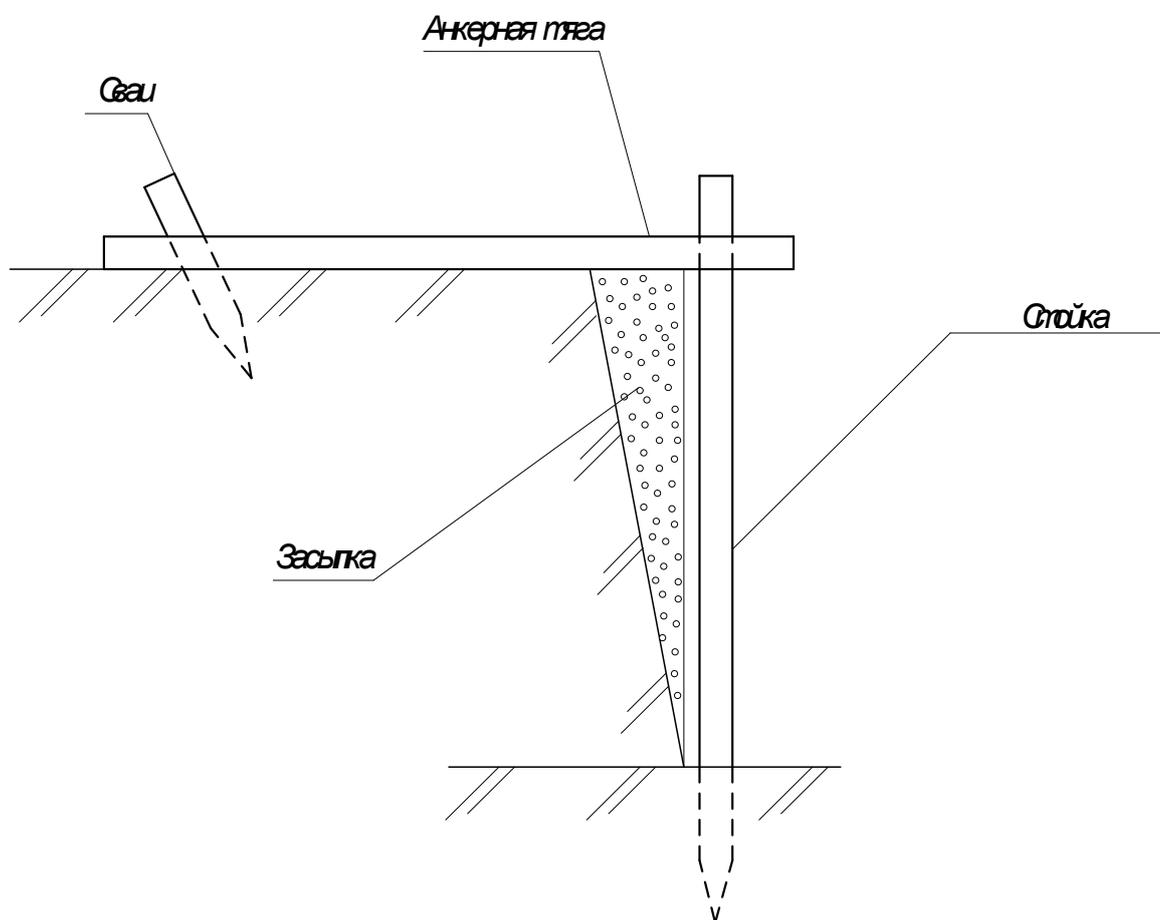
Анкерное крепление стенок котлованов и траншей
